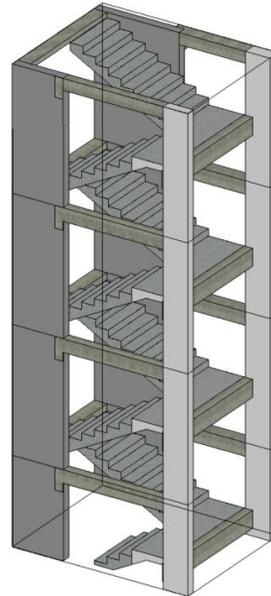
Escaleras del sótano 5 al piso 15, vista en planta.
